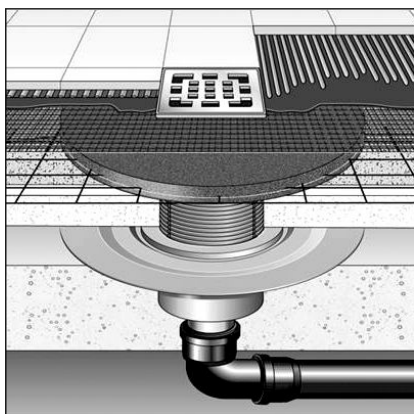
Exemplo geral de montagem - segundo nível de vedação com flange de betão polímero
